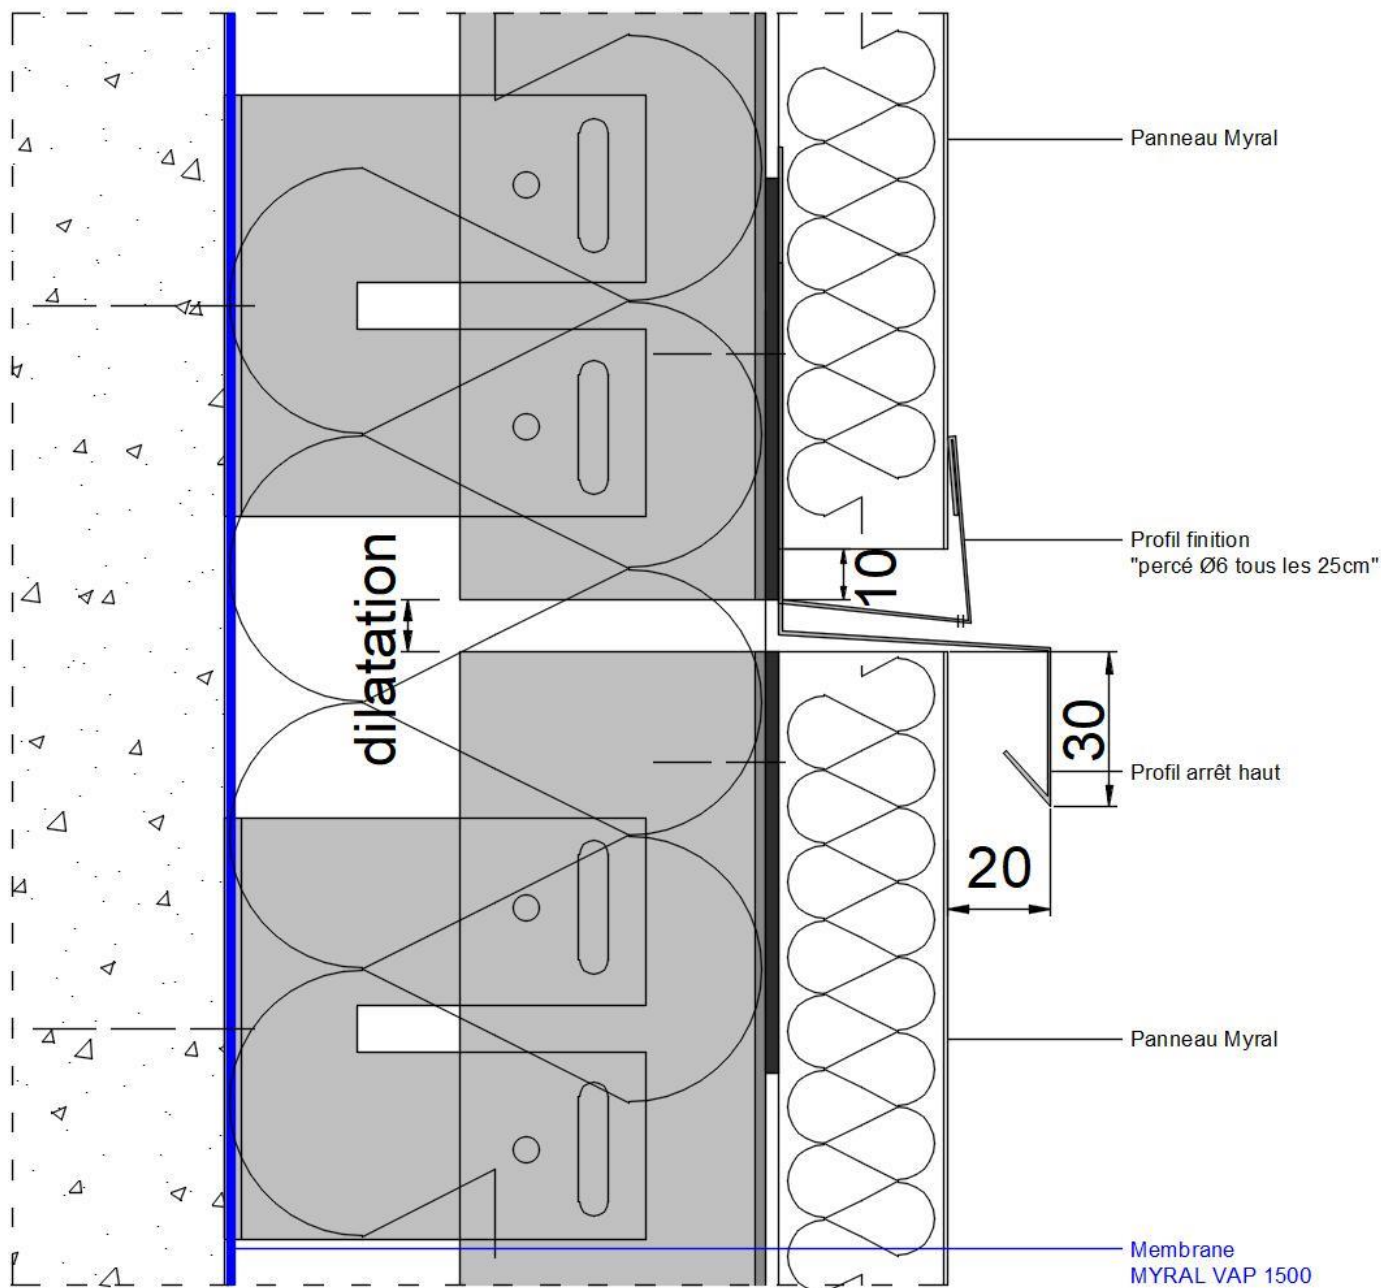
Fractionnement au droit de chaque plancher sur béton
